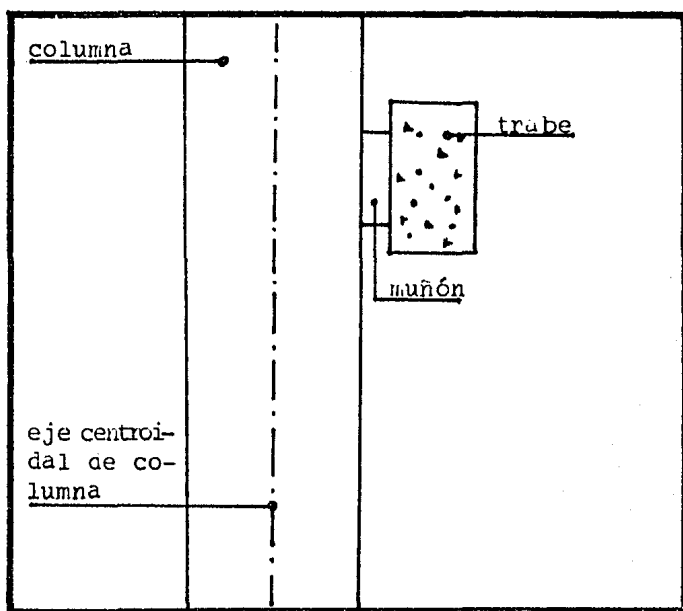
Defectos de estructuración localizadas durante la inspección preliminar en los - - ejes exteriores de construcción (Ejes A, - E y 1).
